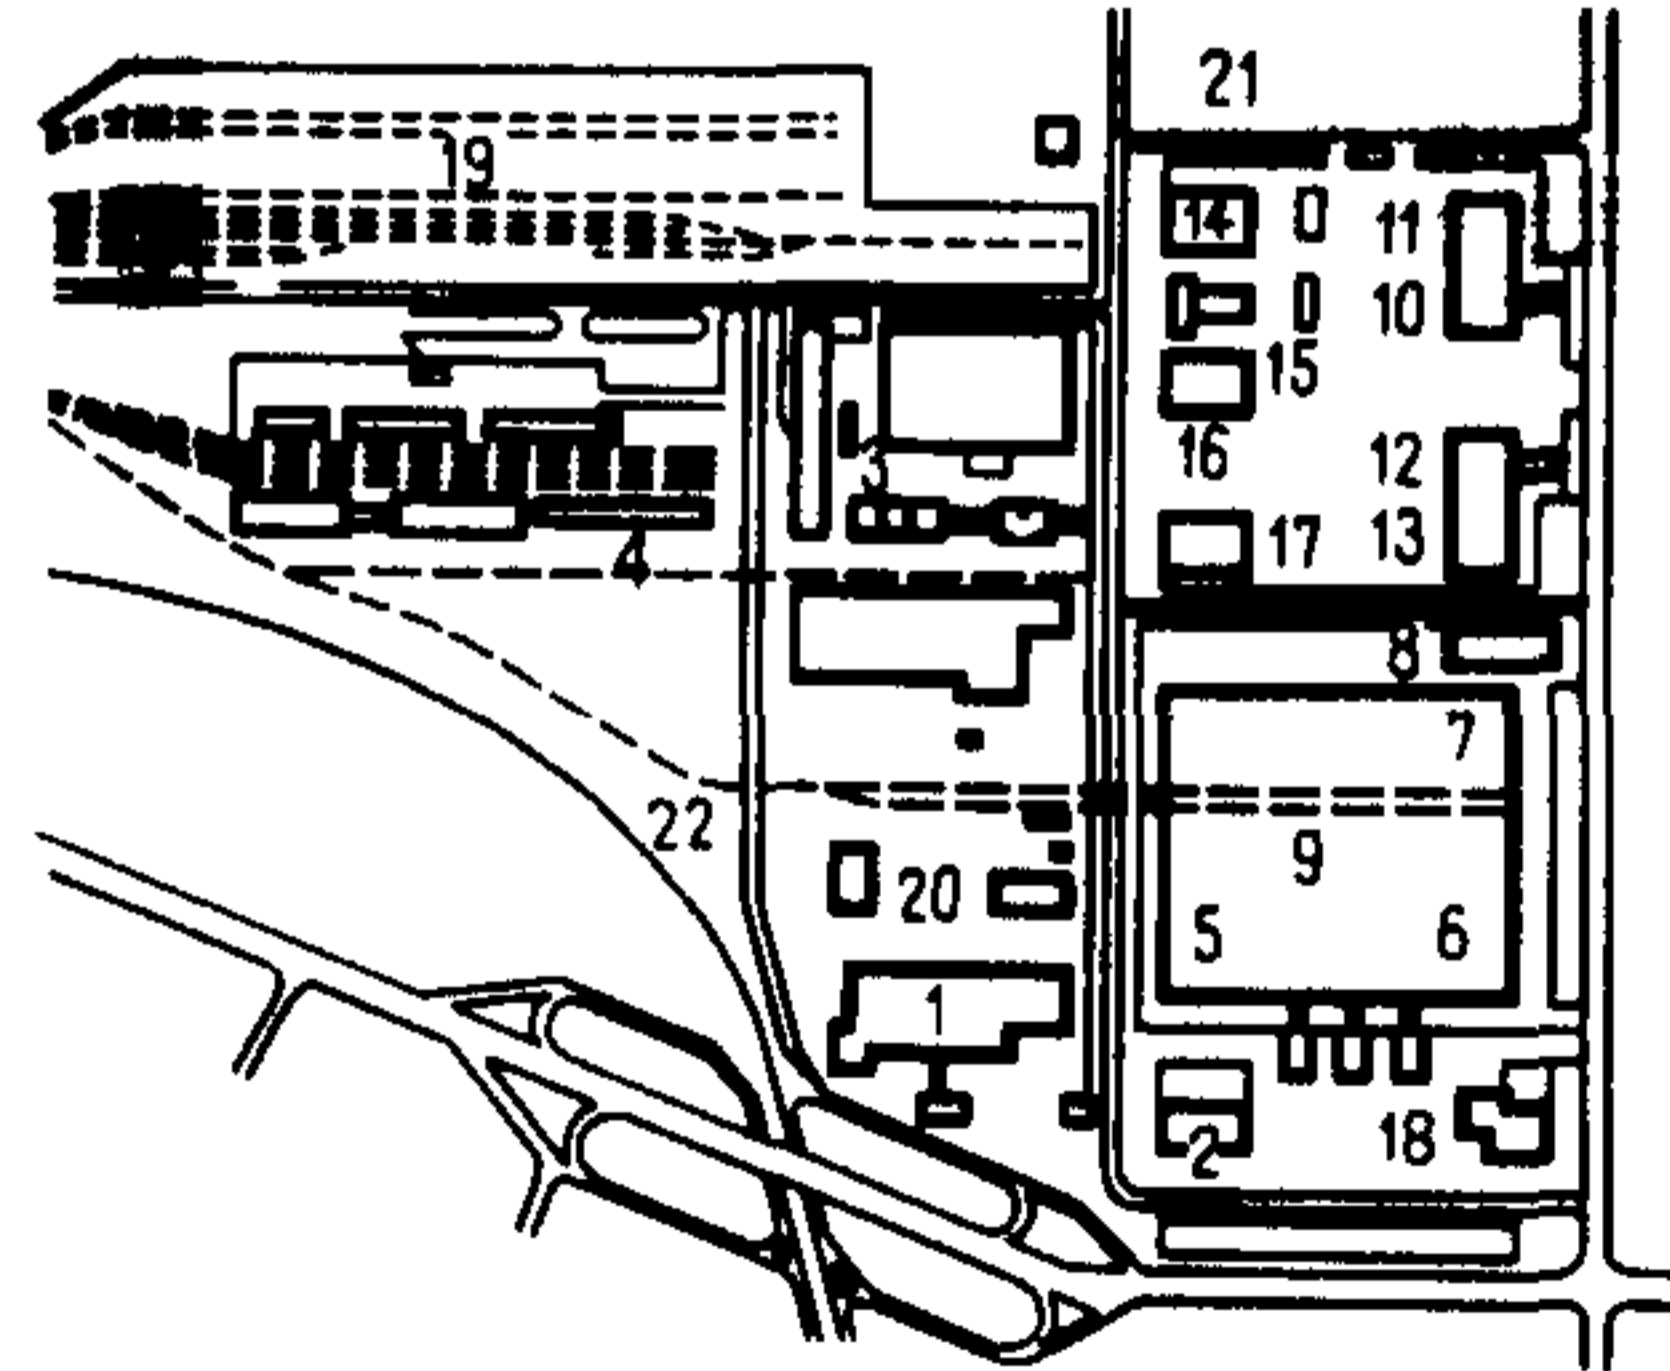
Формирование схем генеральных планов промышленно-коммунальных зон (продолжение)
